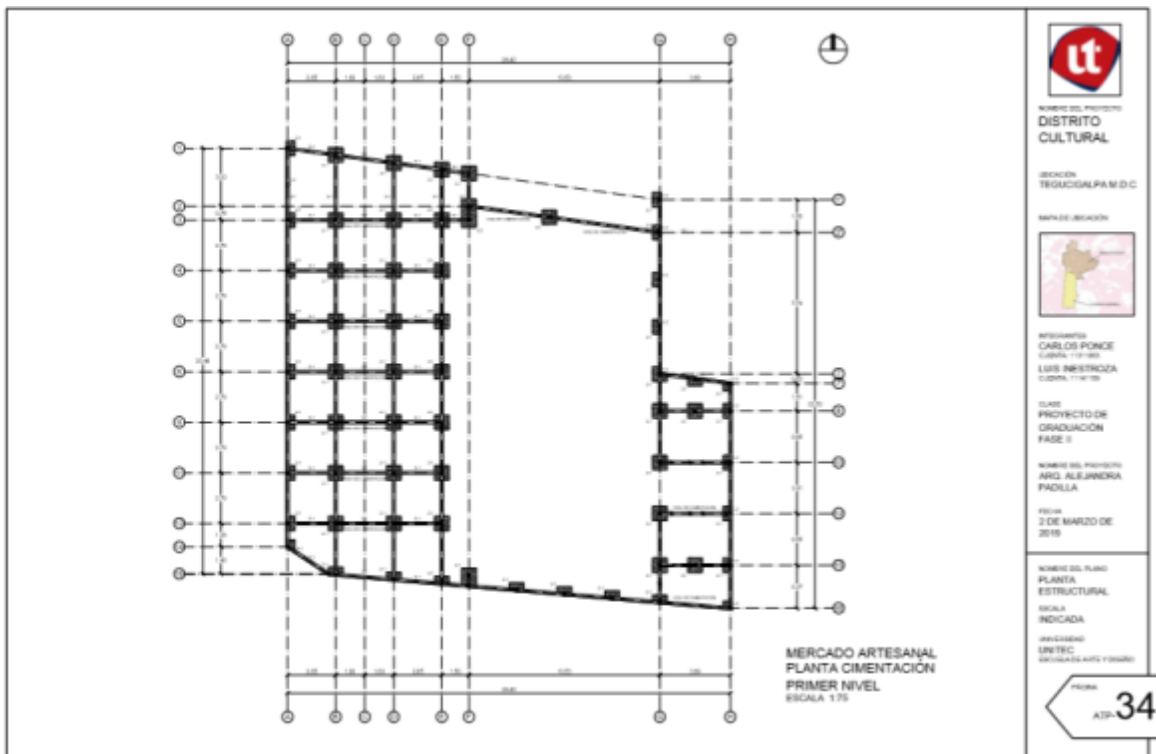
Planta de Cimentación Mercado Artesanal
